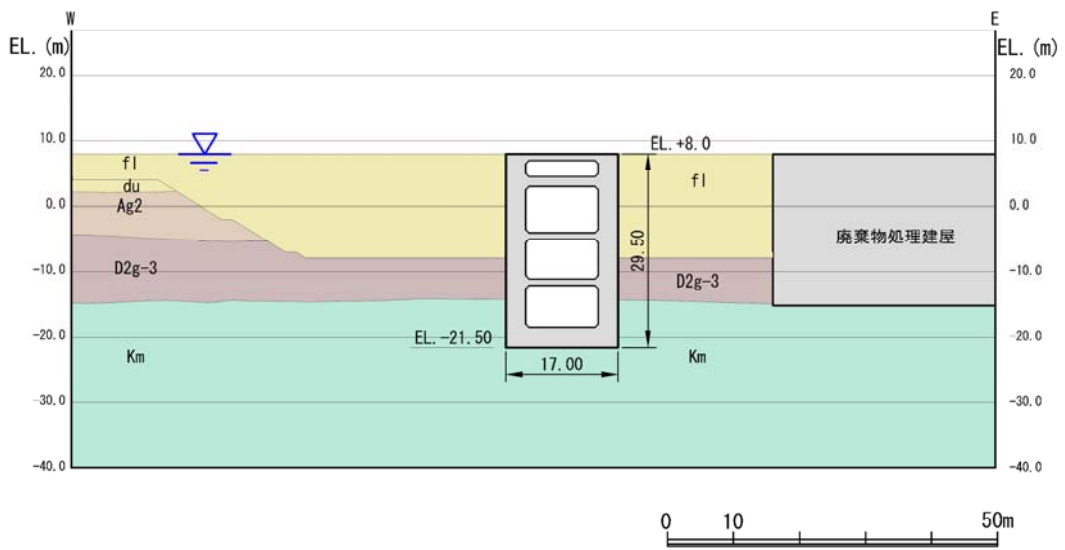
(3) 常設低圧代替注水系ポンプ室地質断面図 (A-A断面)
